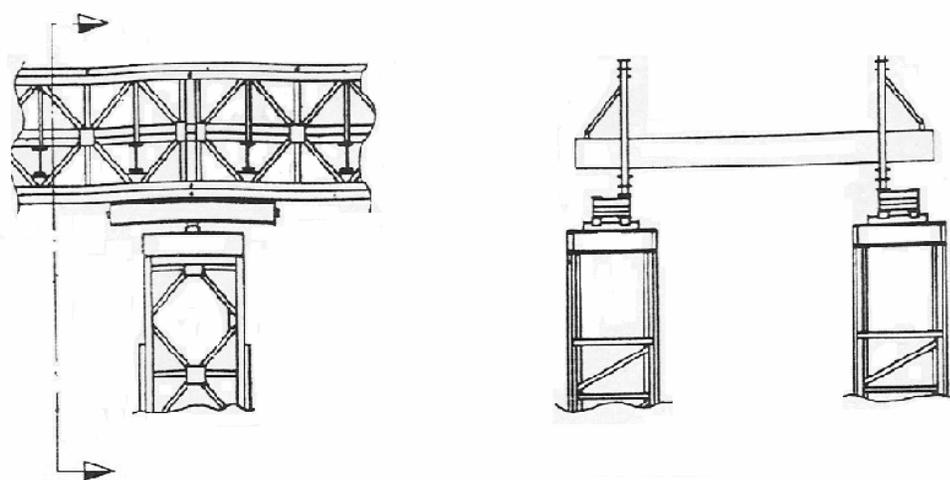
Pilas Bailey con Paneles en Progreso Vertical.
